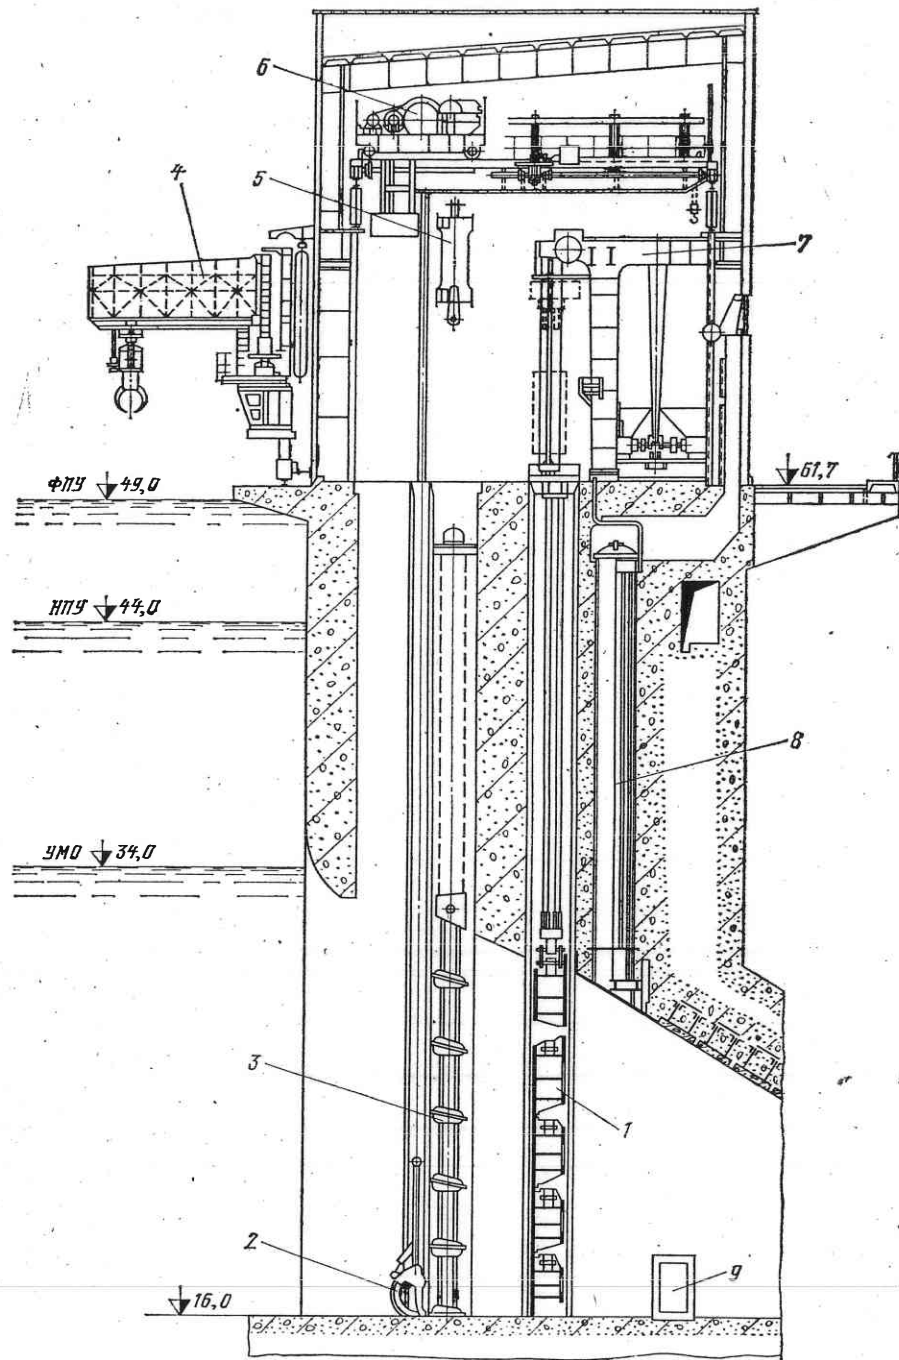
Механическое оборудование водоприемника Вилуйской ГЭС.
